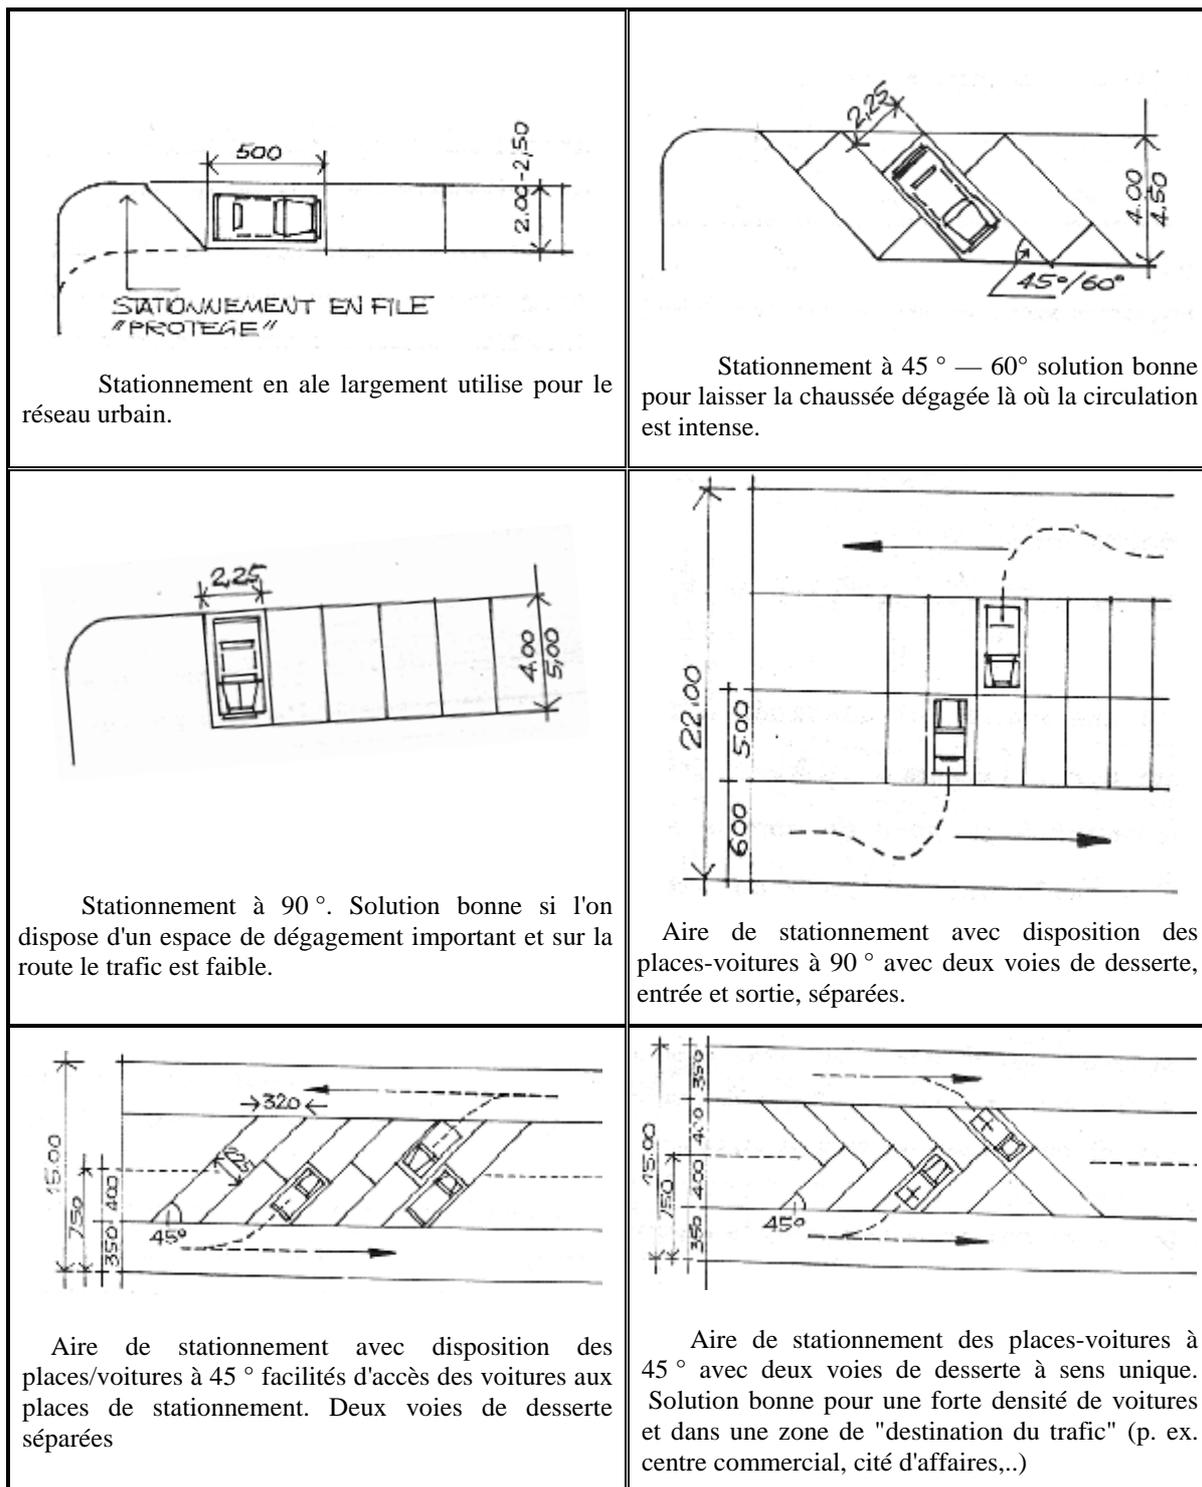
surface nécessaire pour différents modes de disposition des places de stationnement.
